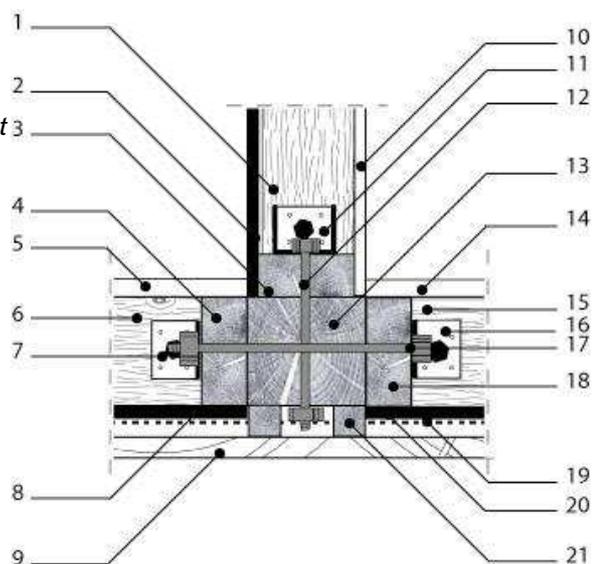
Coupe de principe sur l'assemblage de panneaux murs VT entre un mur de refend et un mur de façade (3 panneaux VT au total)
